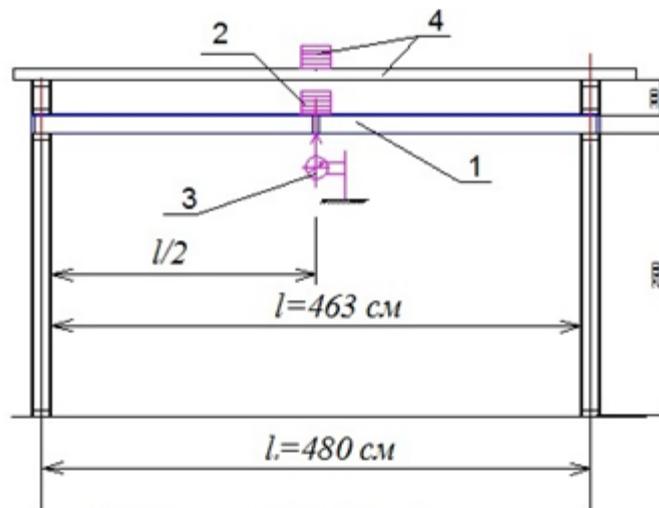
Общий вид испытываемой конструкции с пригрузом: 1 - фрагмент перекрытия, 2 – грузы, 3 – прогибомер, 4 - пригруз
